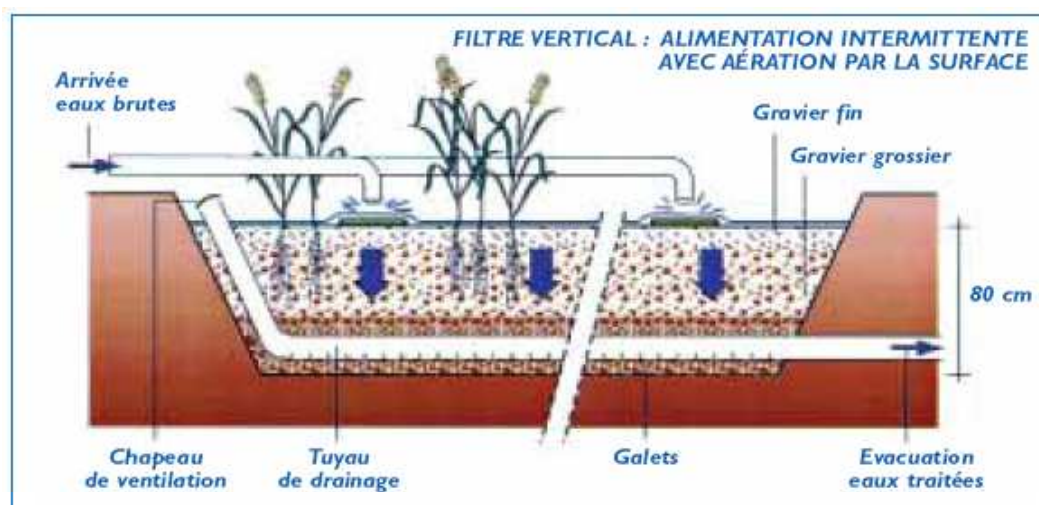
Coupe transversale d'un filtre planté de roseaux à écoulement vertical
